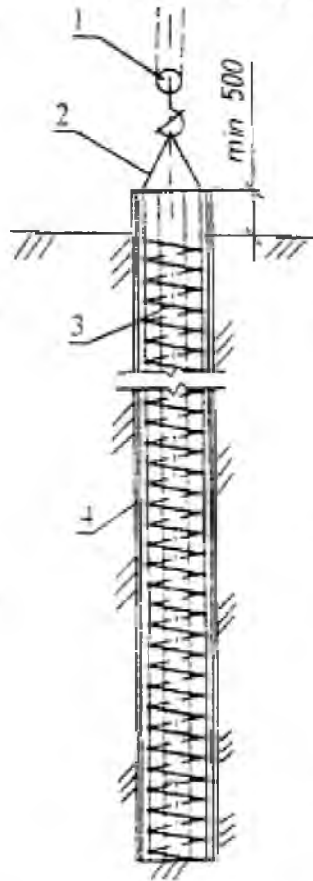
Встановлення арматурного каркаса залізобетонної конструкції палі
